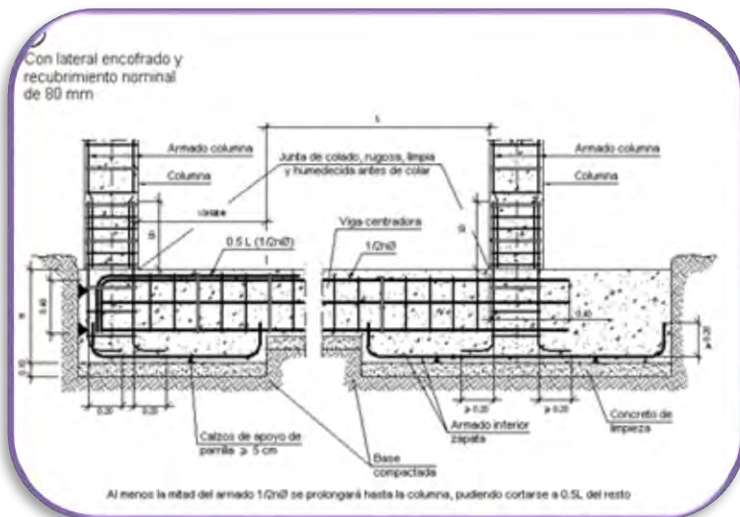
ejemplo de una zapata centrada con otra zapata aislada
